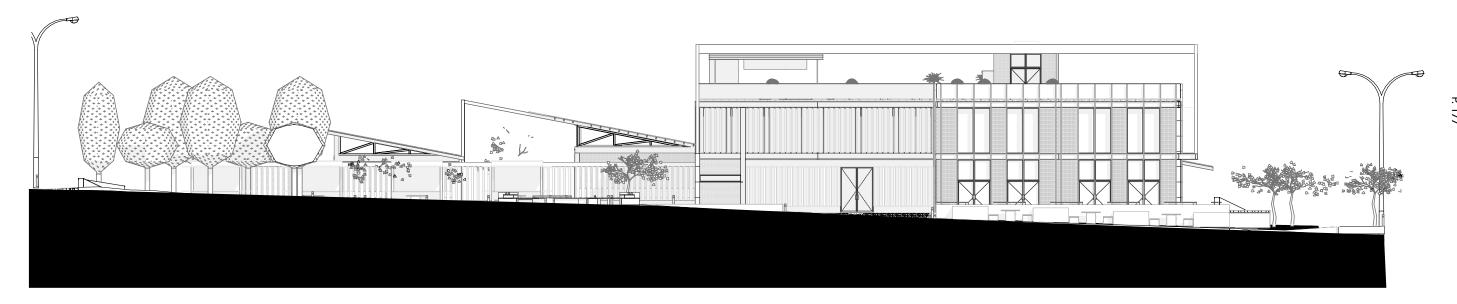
Fachada biblioteca Fuente: Elaboración propia 2023.
